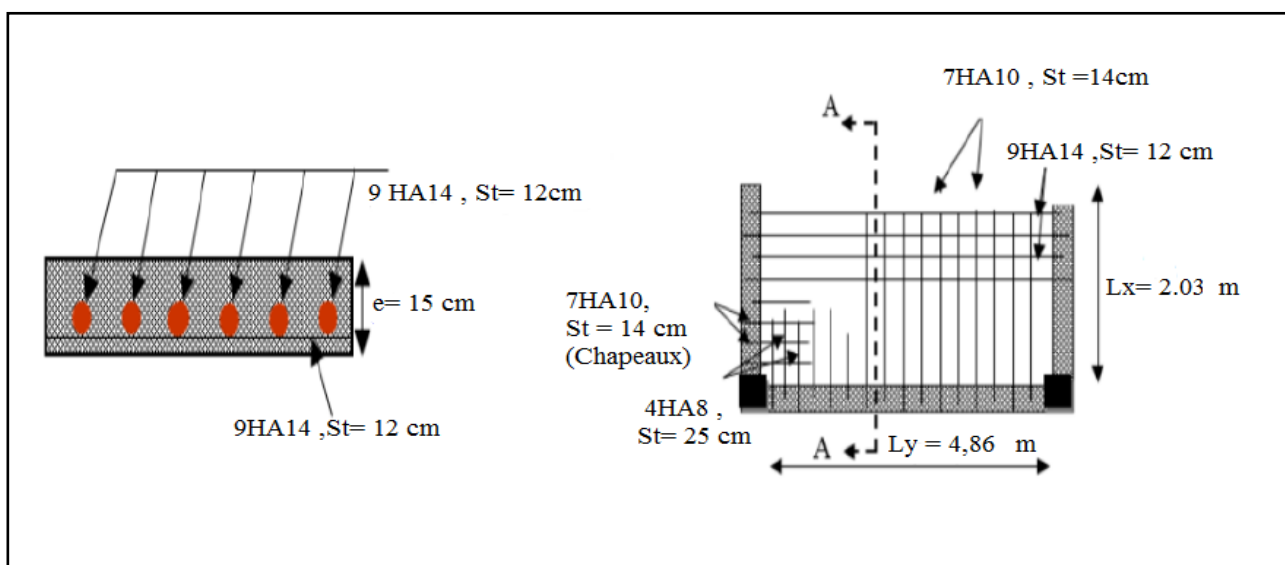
Schéma de ferrailage de la dalle sur 3 appuis
